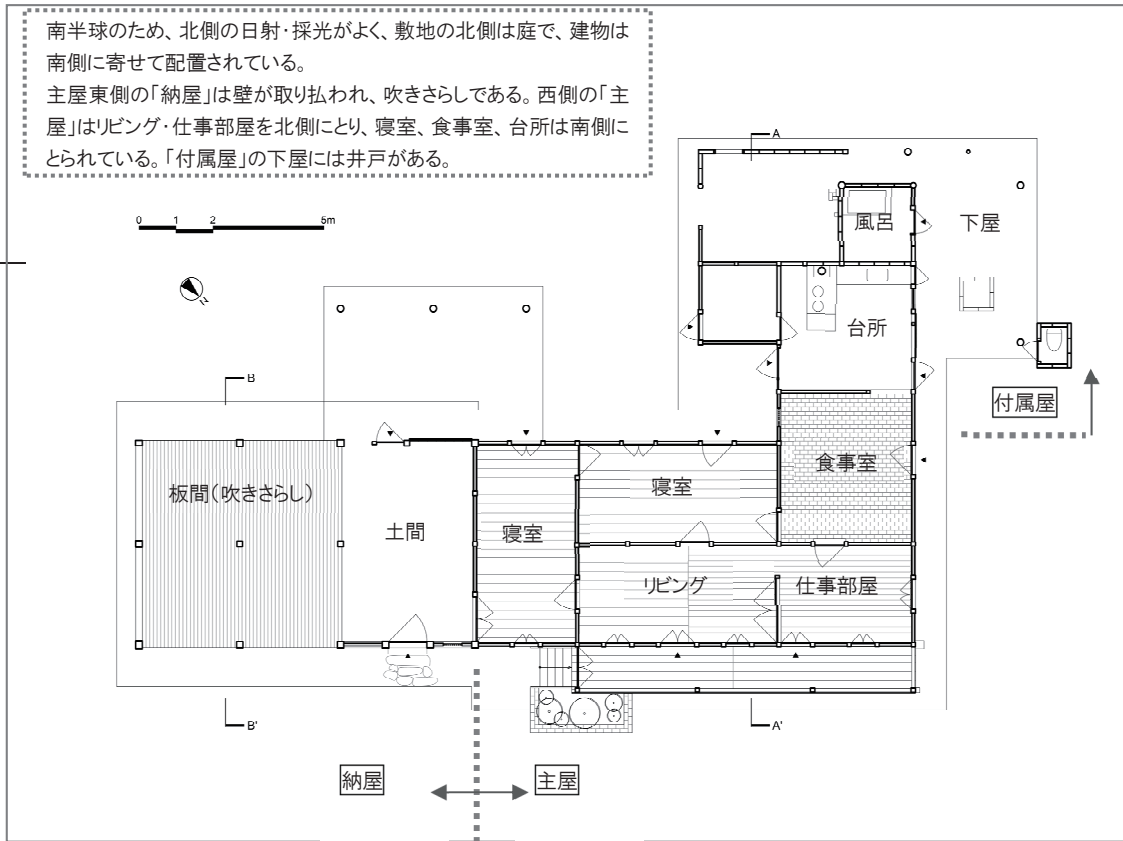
沖山剛造家住宅 平面図 (実測調査による)
